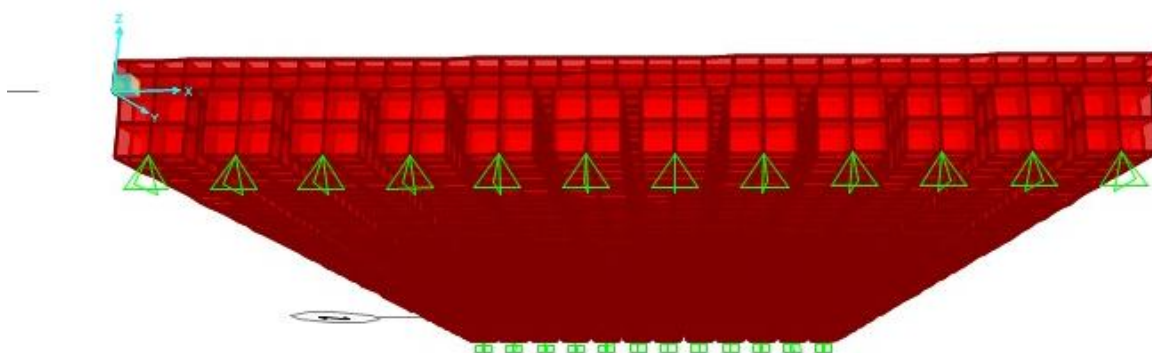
Vista em três dimensões da parte inferior do tabuleiro de madeira-concreto para o modelo 3. Fonte: O autor.
